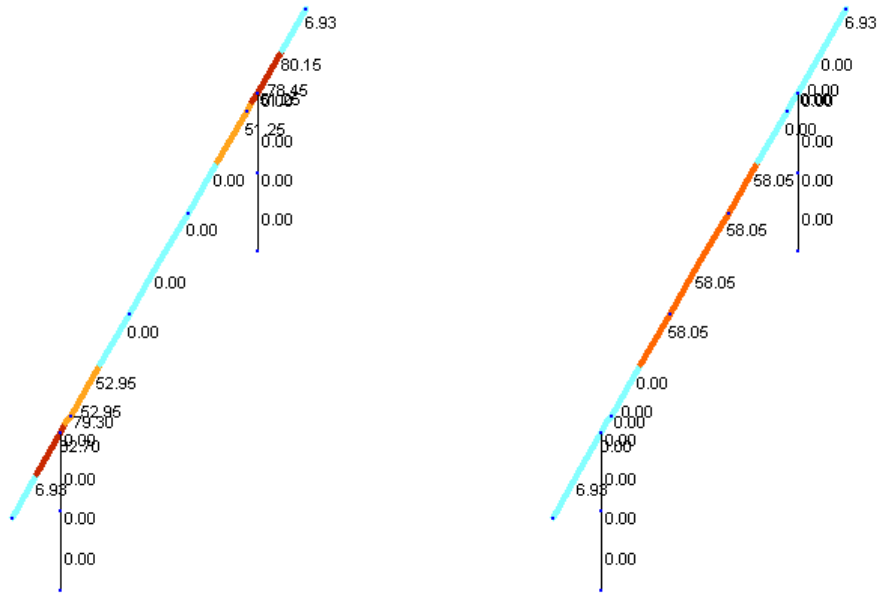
Сумарна площа верхнього і нижнього пояса арматури ригеля опори № 5
